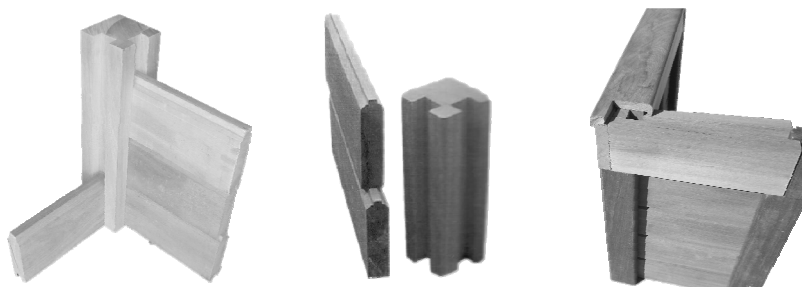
Detalhes das tábuas aparelhadas pelo sistema macho-fêmea e encaixadas em montantes maciços (adaptado de HUMAITÁ, 2008)
